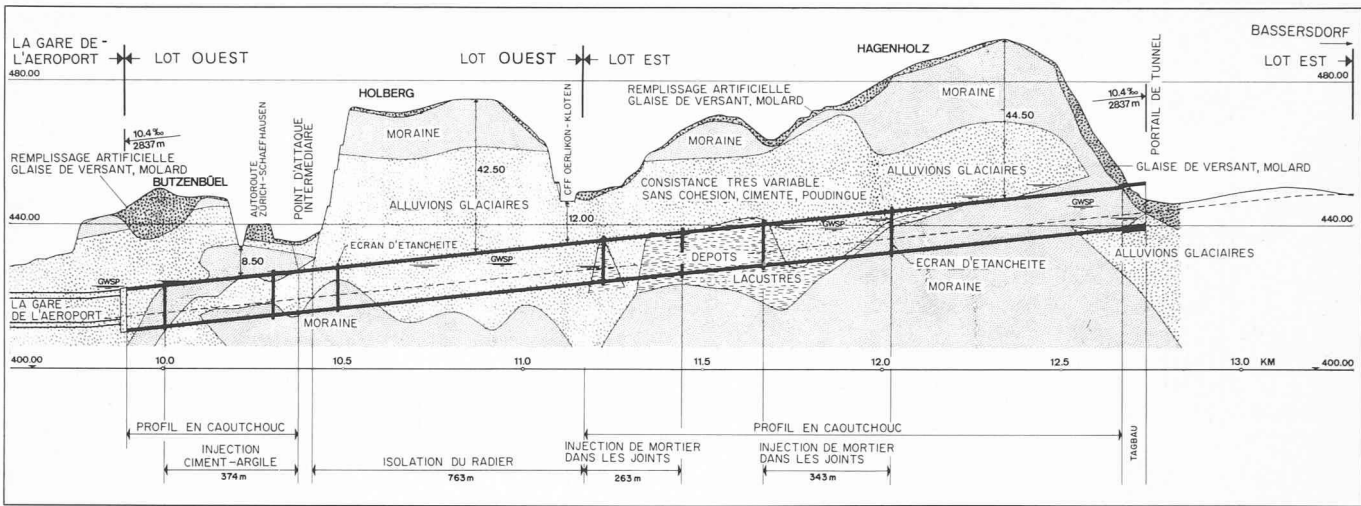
Profil géologique longitudinal du tunnel du Hagenholz.
